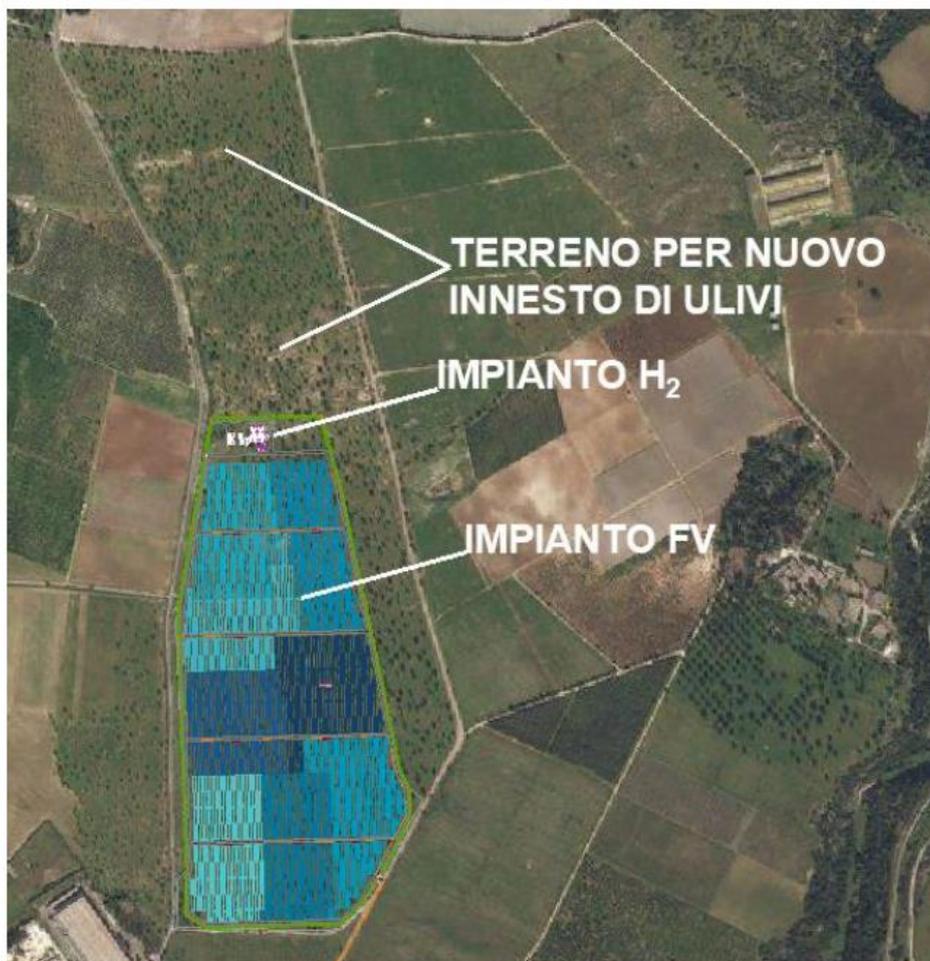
Ortofoto con individuazione delle aree occupate dall'impianto fotovoltaico e dell'impianto di produzione di idrogeno verde
